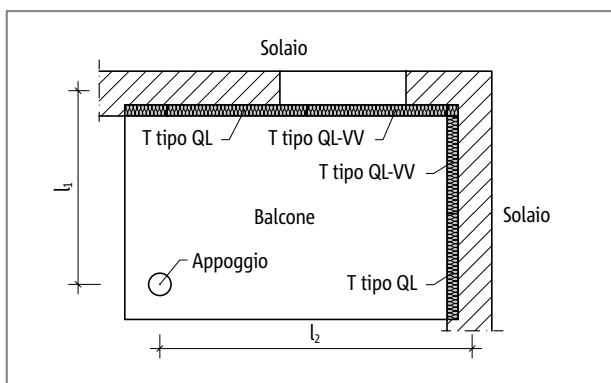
Schöck Isokorb® T tipo QL, QL-VV: balcone appoggiato su due lati con pilastro
